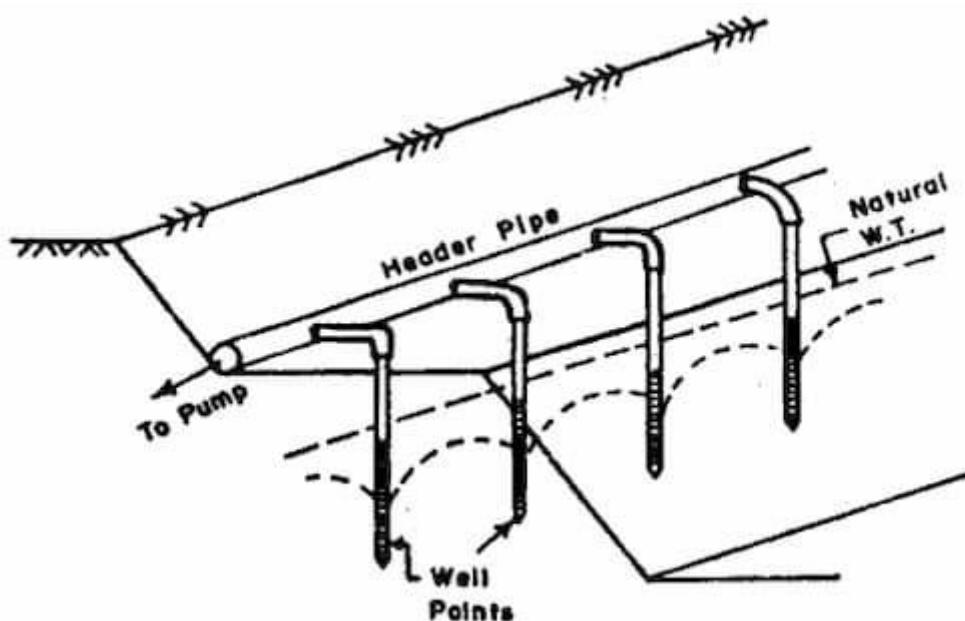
Schema di un sistema di drenaggio wellpoint
